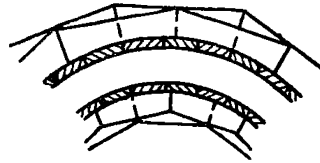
Кружала для опалубки криволинейных стен (в два слоя досок).
